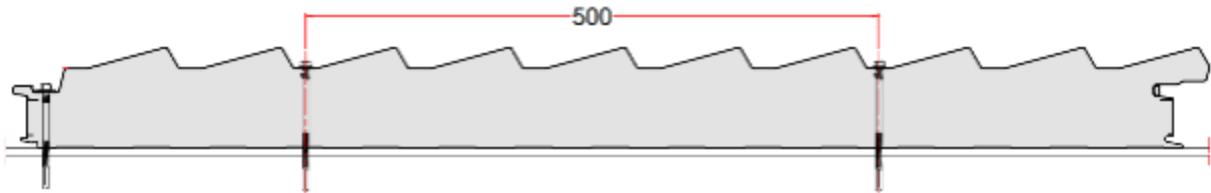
ter – Dispositions complémentaires sur façade inclinée à fruit positif maximal 10° (inclinaison vers l'intérieur) – Rive contre mur
